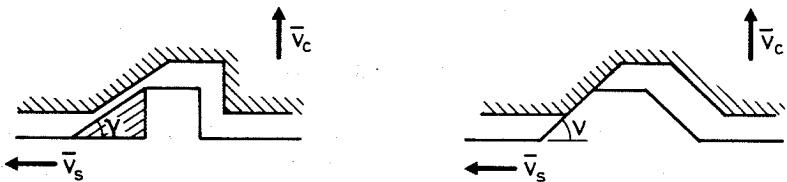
Betonbrud omkring kam og glidning i overgangen beton/armering
